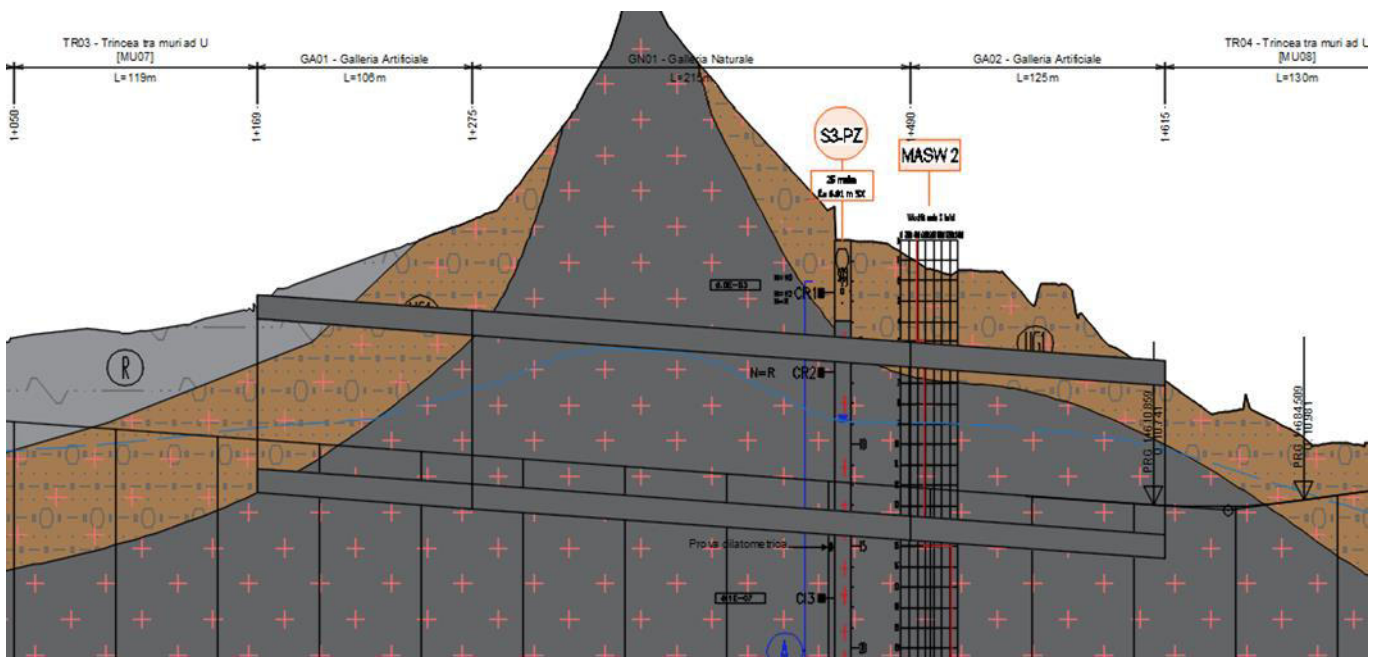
Stralcio del profilo Geotecnico alle pk di interesse
